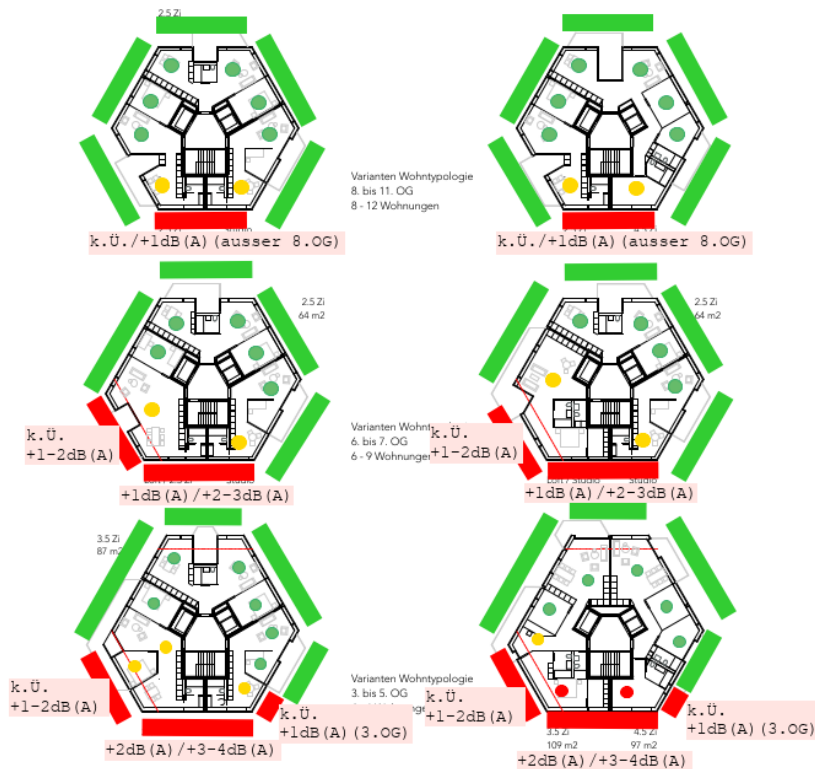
Beurteilung der Grundrisse mit dem Ampelsystem, Details siehe Beilage 2.
